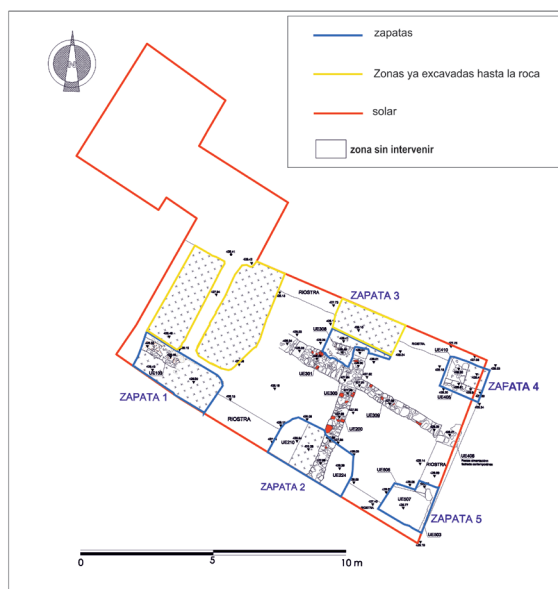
Solar y zonas excavadas. En azul zonas de las zapatas de cimentación excavadas parcialmente en nuestra intervención. En amarillo zonas ya vaciadas previamente. En blanco zonas no intervenidas.
